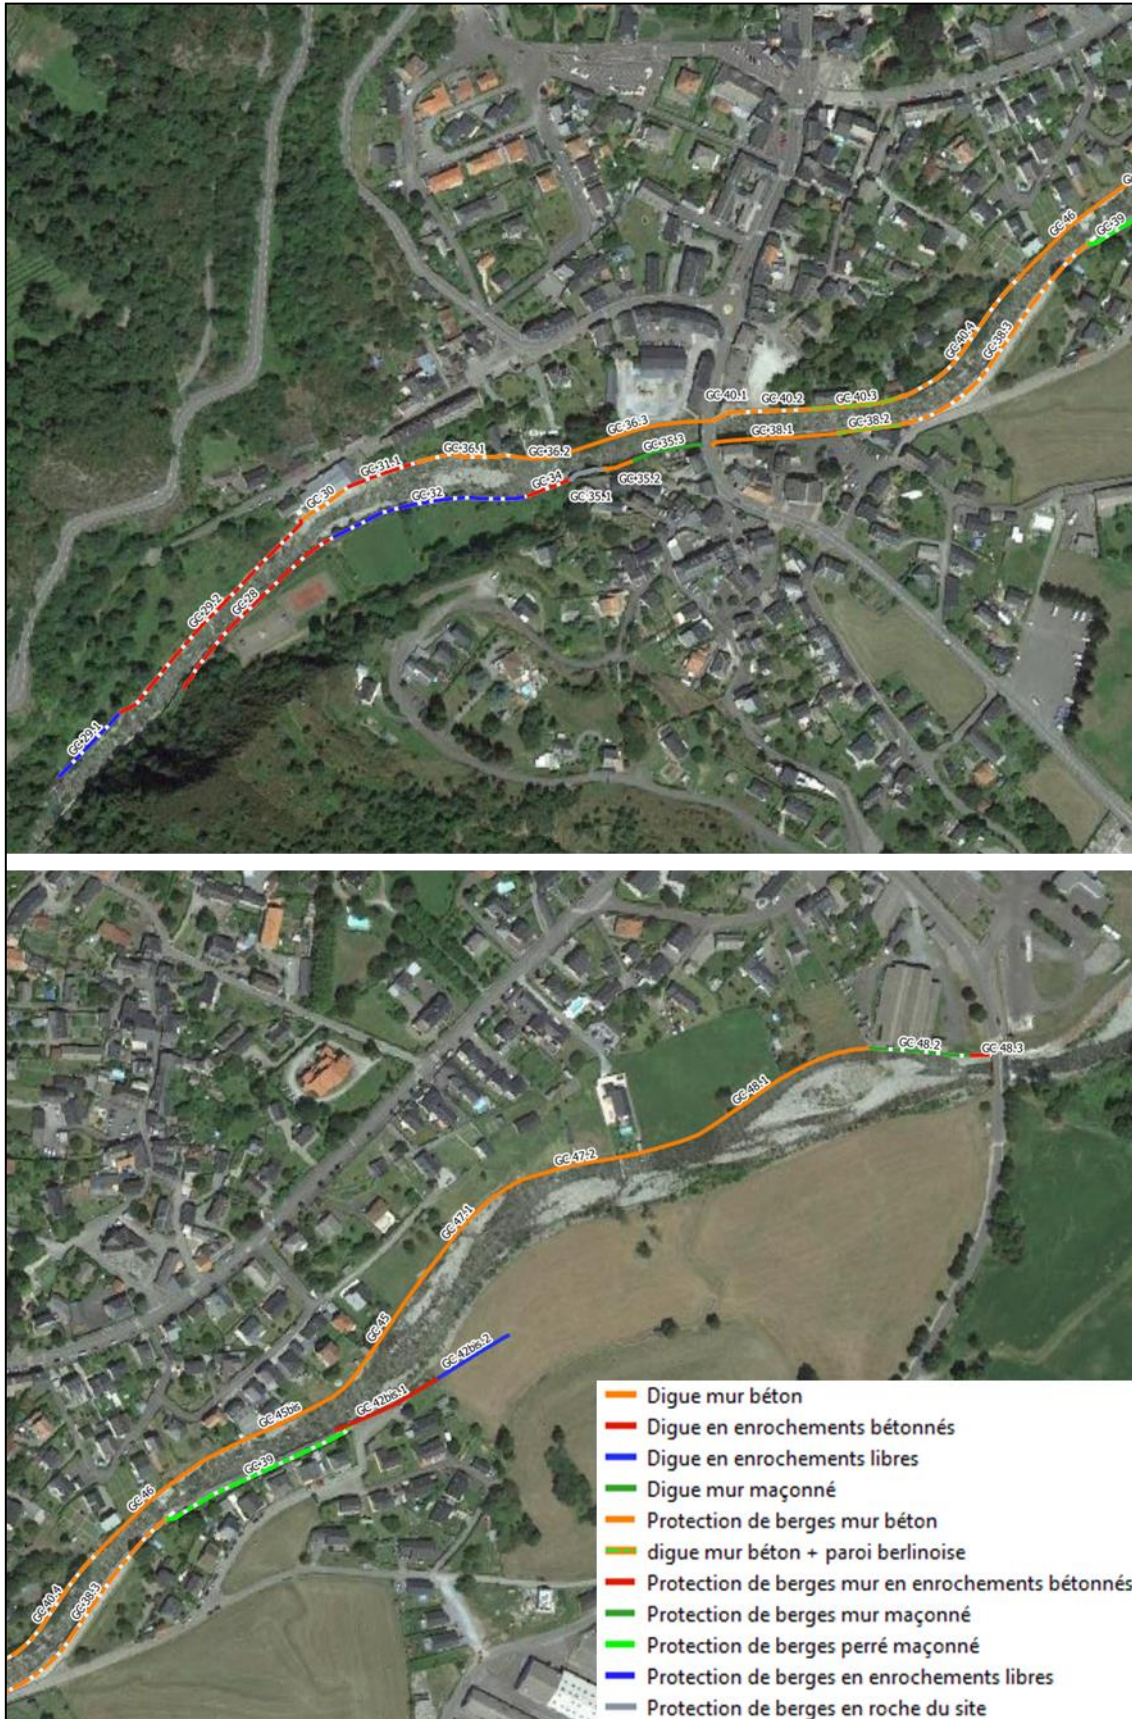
Vue en plan des ouvrages constitutifs du système d'endiguement
